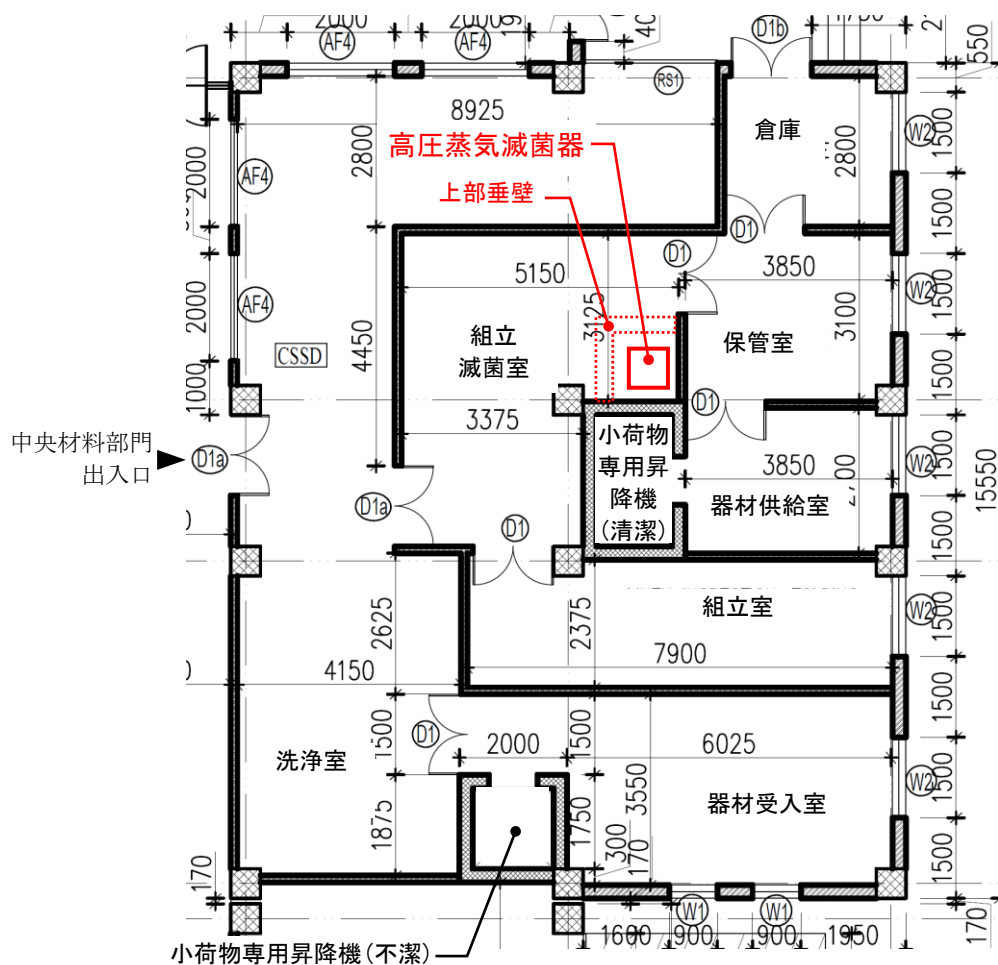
BLOCK-3 地下1階平面図（東部地域母子保健病院）
